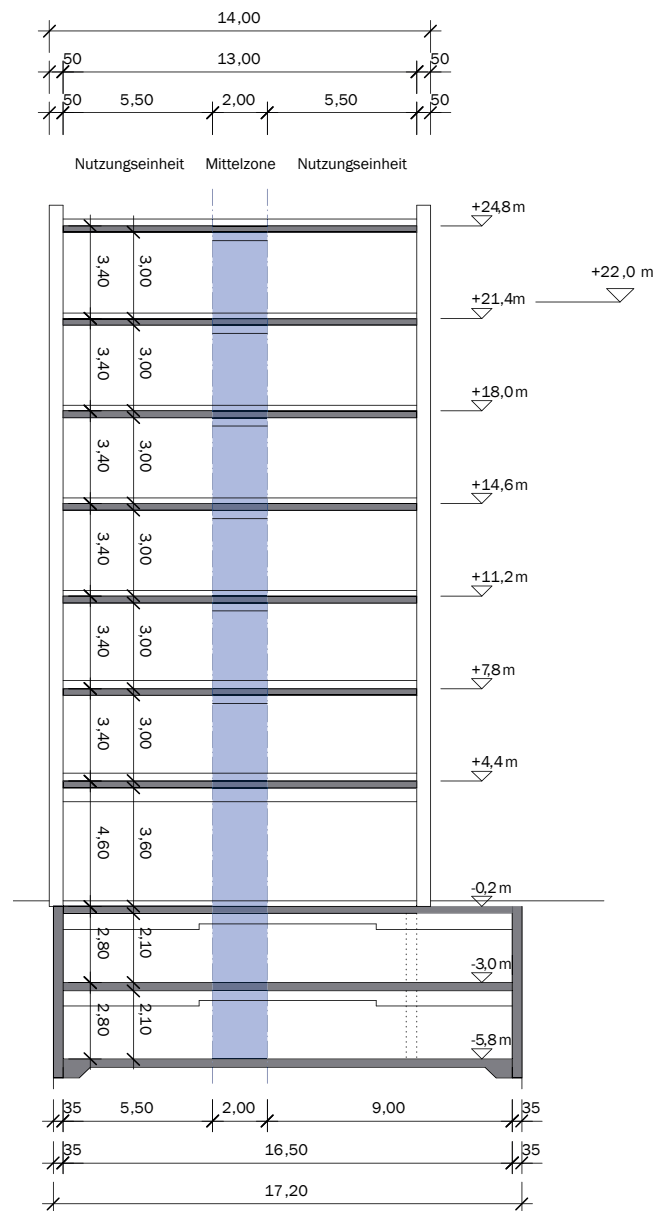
Anpassungsfähige Gebäudestruktur mit sieben oberirdischen und zwei unterirdischen Geschossen
